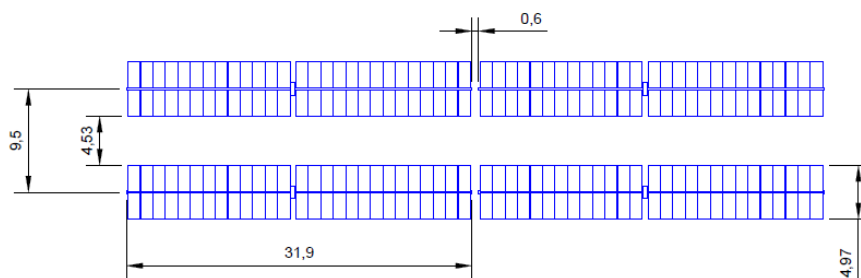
Vista in pianta di quattro tracker (quote espresse in metri)
